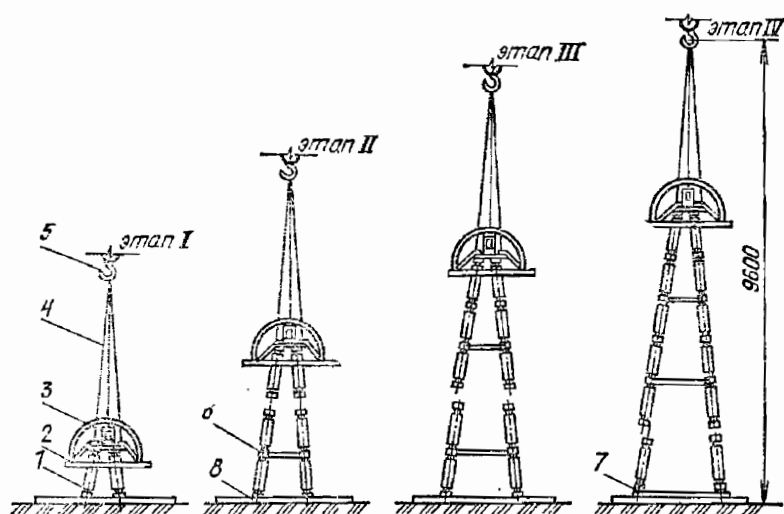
Схема сборки шинной опоры ШО-750:
